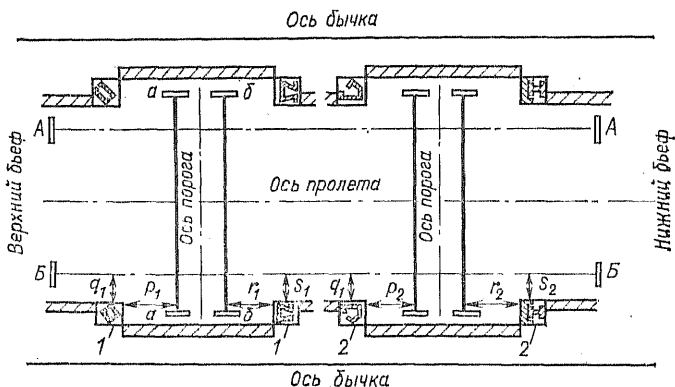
Схема разбивки осей для контроля установки пазовых конструкций затвора плотины
